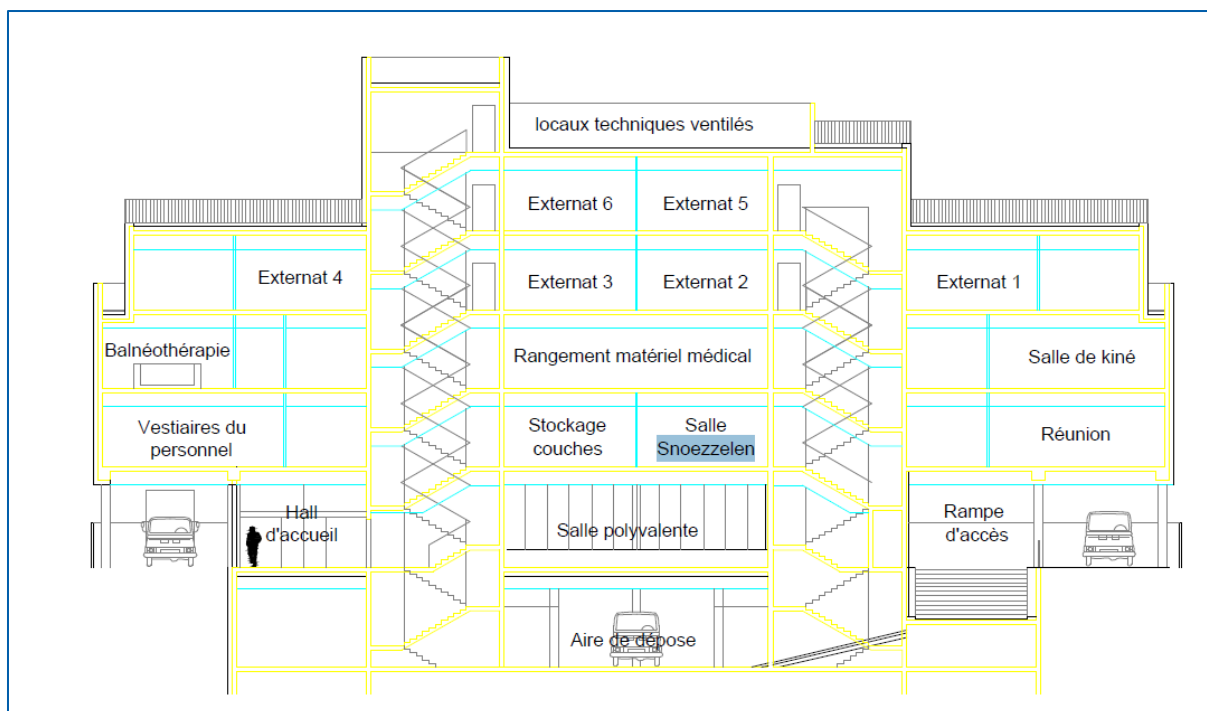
Plans de coupe de l'IME – KAUFMAN & BROAD 2024
